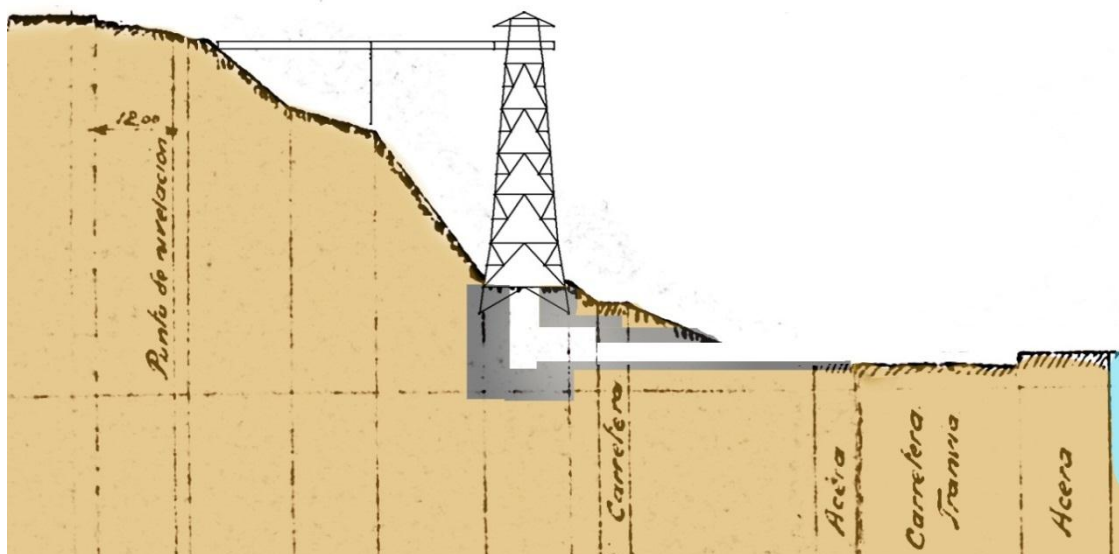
Plano del proyecto de ascensor de Miramar
